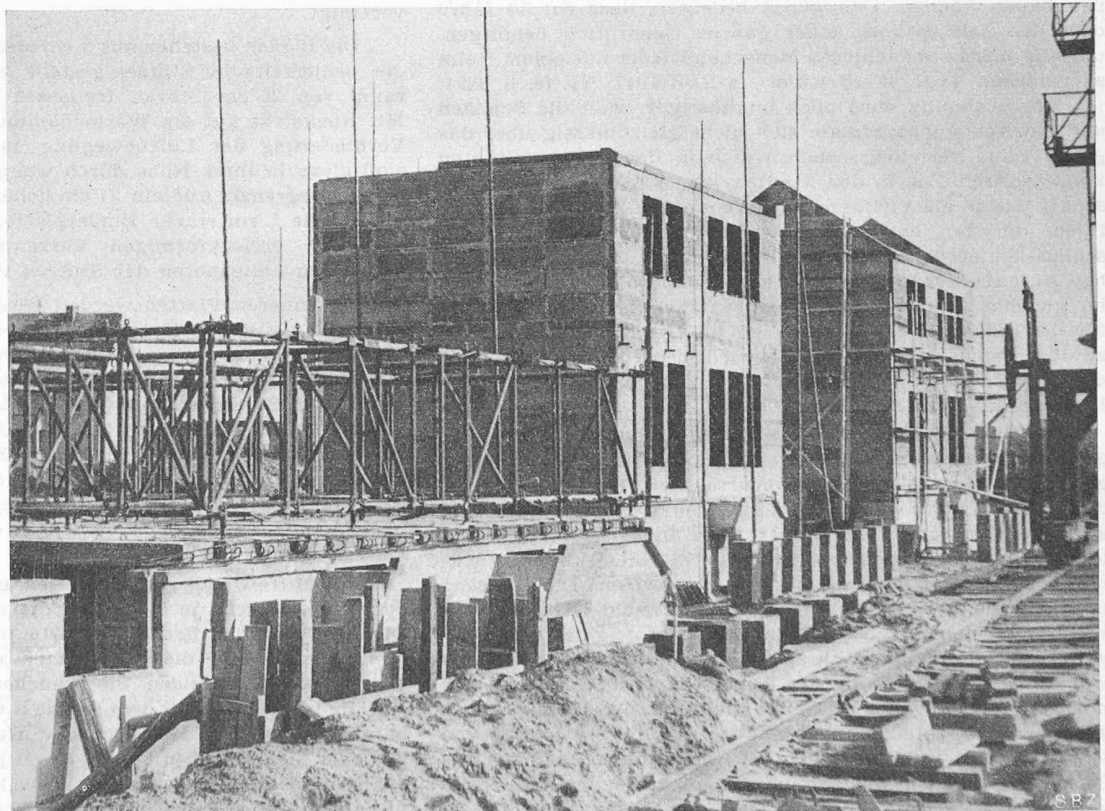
Im Vordergrund ein Haus mit dem Montagegerüst auf der Kellerdecke
